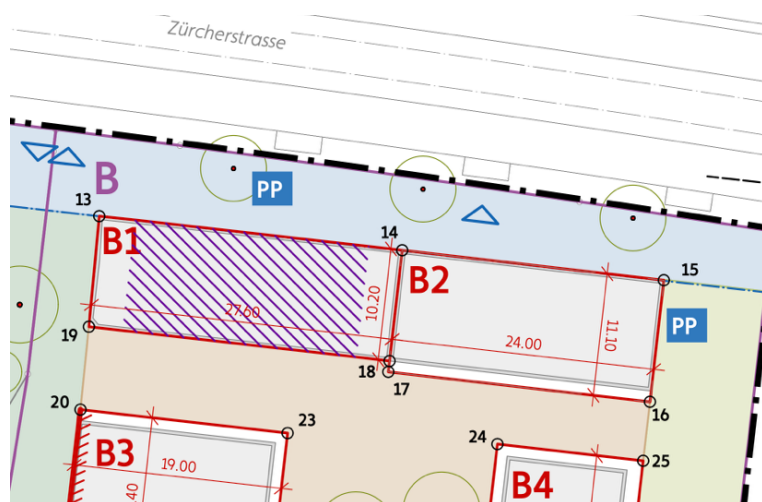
Ausschnitt Gestaltungsplan mit den Baubereichen B1 und B2 für den möglichen Standort einer Kinderkrippe (Plan genordet)
